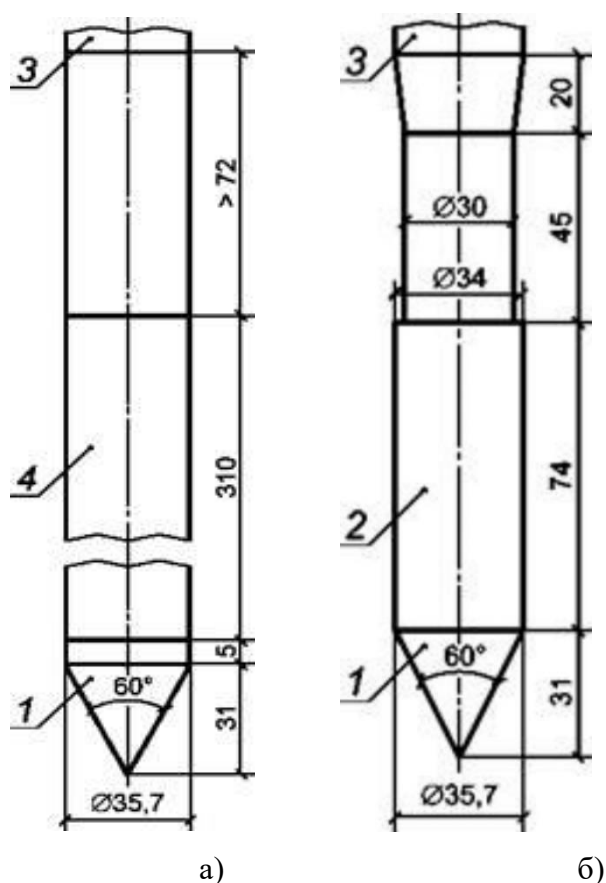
Схема конструкции зондов: а) - II типа; б) - I типа. 1 - конус; 2 - кожух, 3 - штанга; 4 - муфта трения
